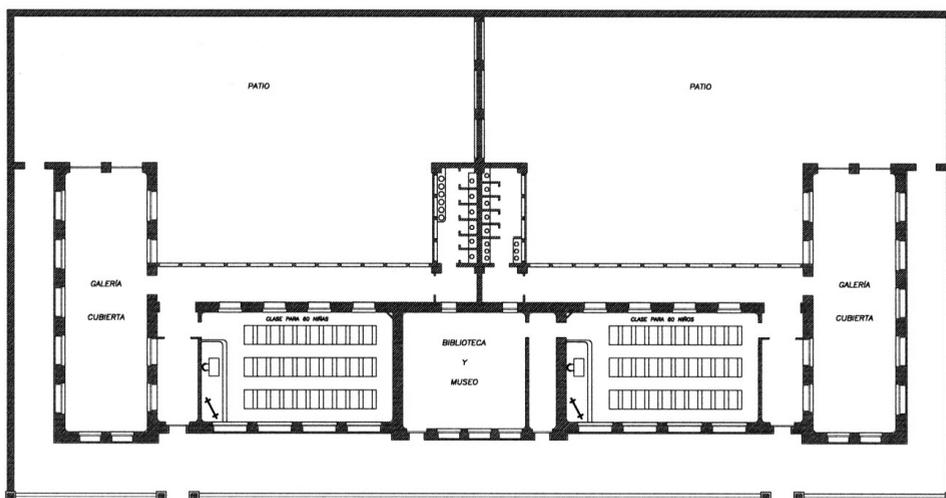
Grupo escolar para 60 alumnos y 60 alumnas (redibujado por el autor).
